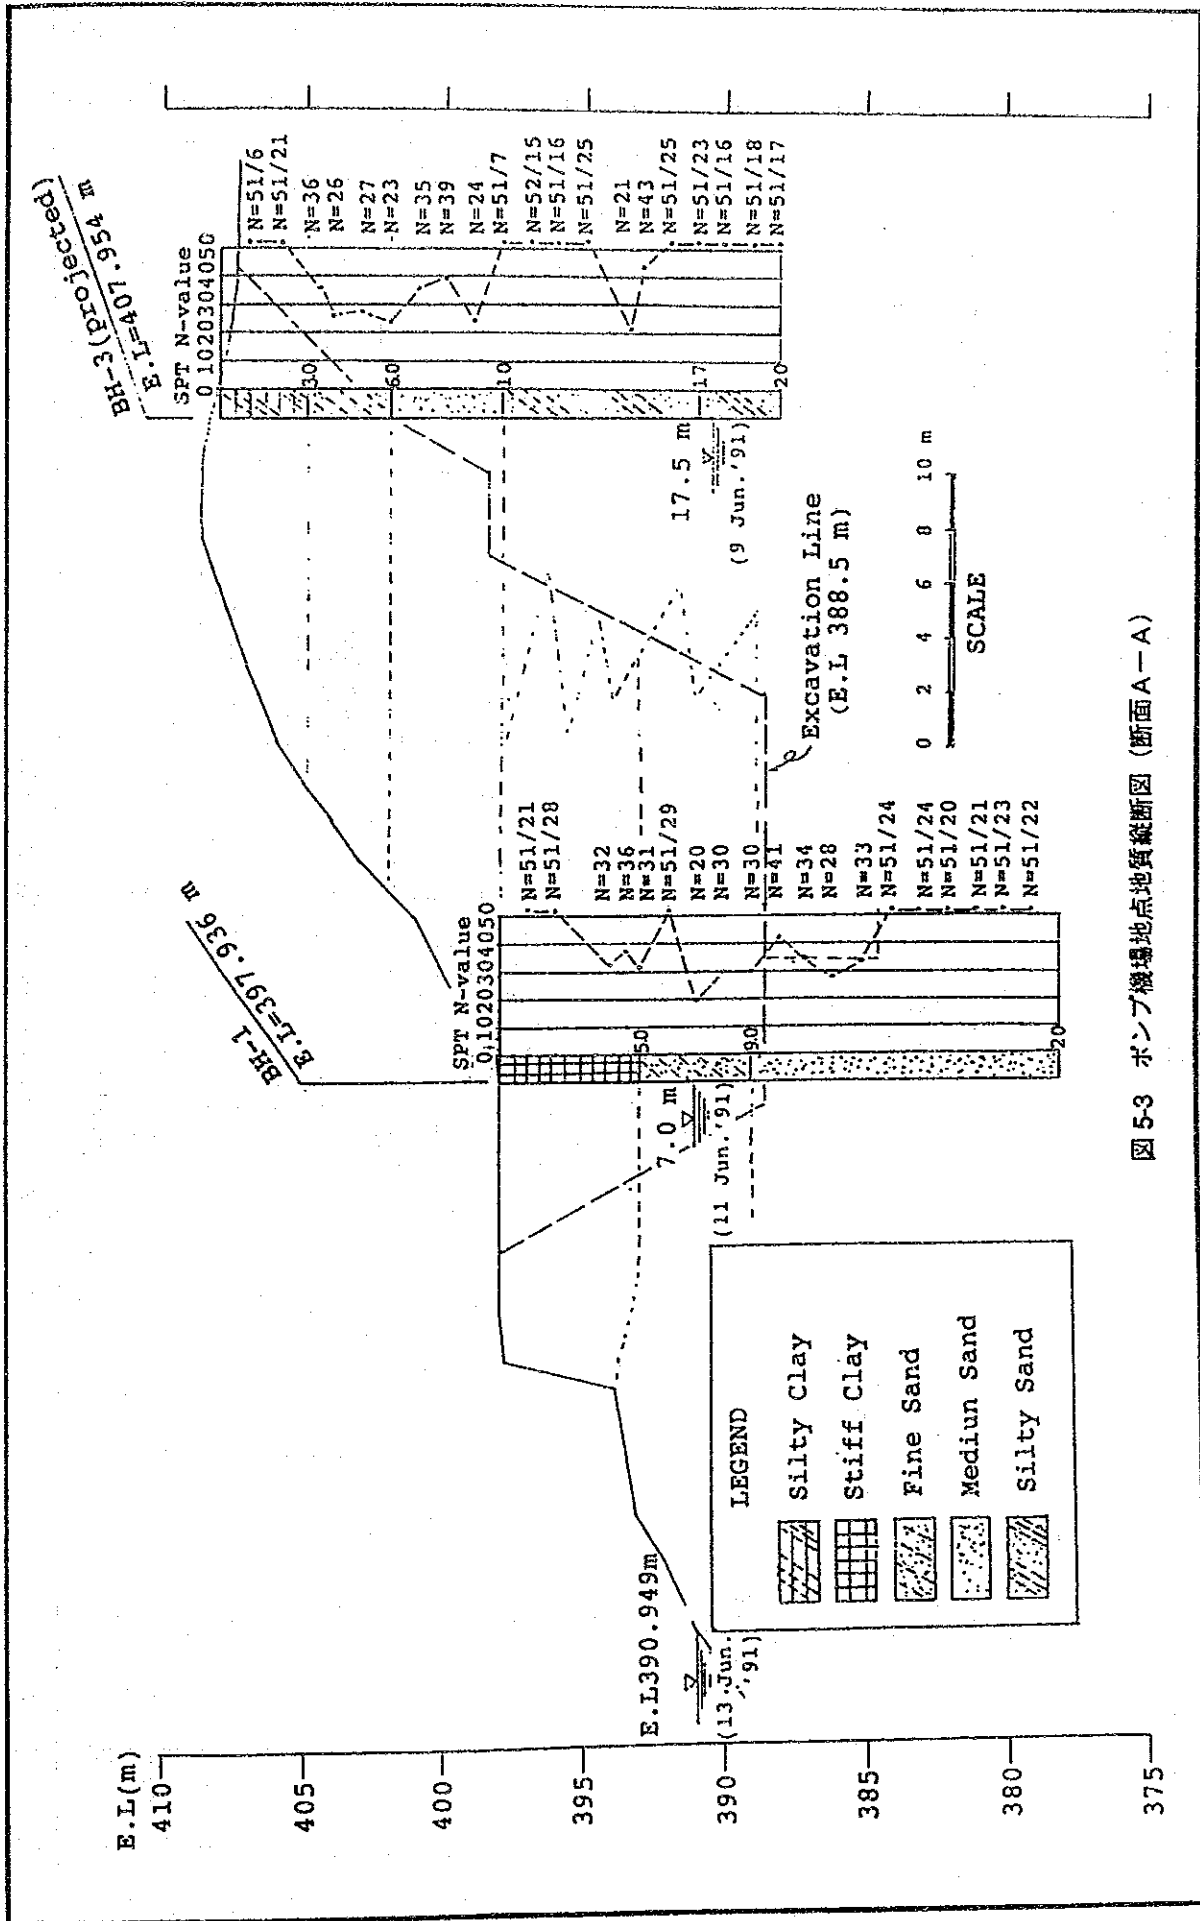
ポンプ機場地点地質縦断面図 (断面A-A)
